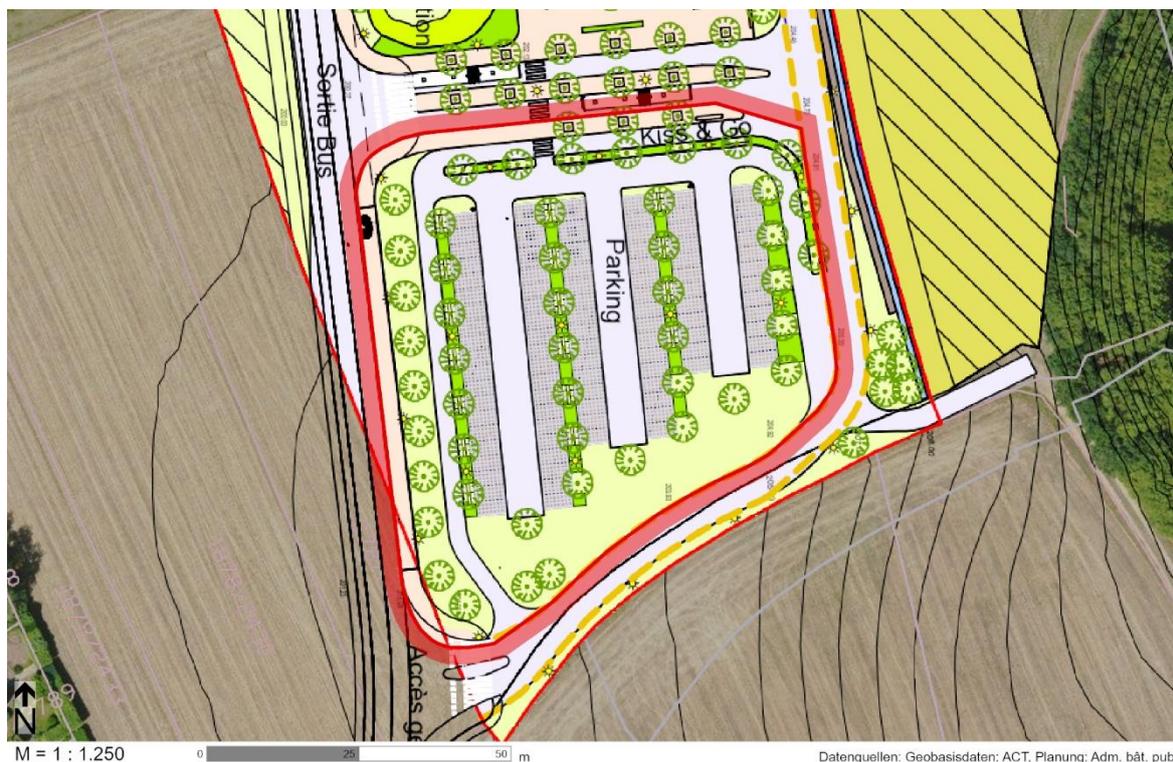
Abgrenzung des Parkplatzes im Lageplan mit Nutzungen und Bodenbedeckungen und hinterlegtem Orthofoto
